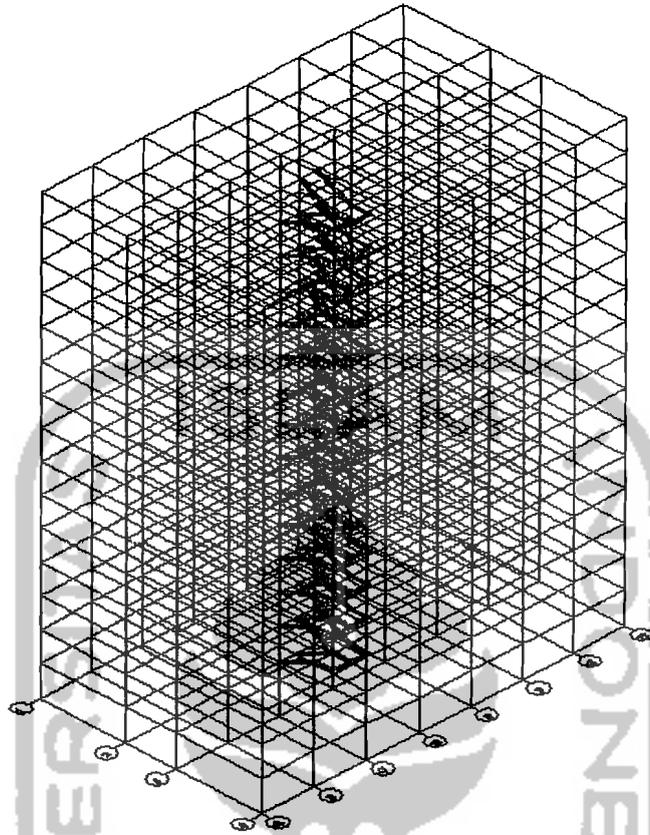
Balok dan Kolom Satu Tangga
